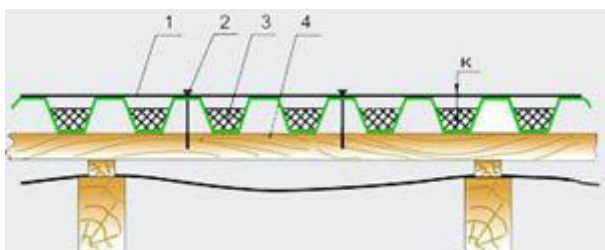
Крепление конька: 1 - конёк; 2 - саморез; 3 - уплотнитель коньковый; 4 - обрешётка; К - вентиляционный зазор
